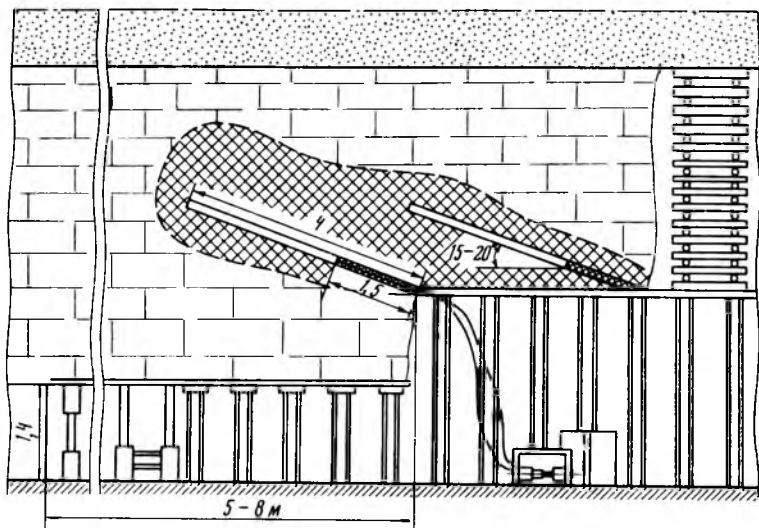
Схема укрепления неустойчивой кровли полиуретановыми смолами
